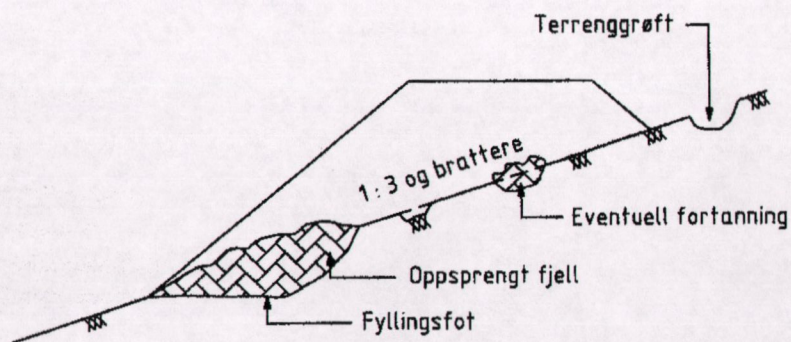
Fyllingsfot ved lagvis utlegging.
